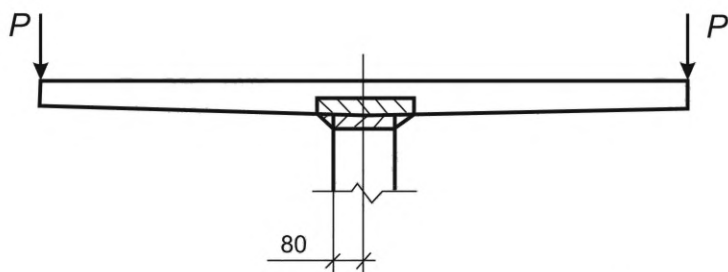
Схема испытания ступеней типоразмеров ЛСС 12 и ЛСС 15
